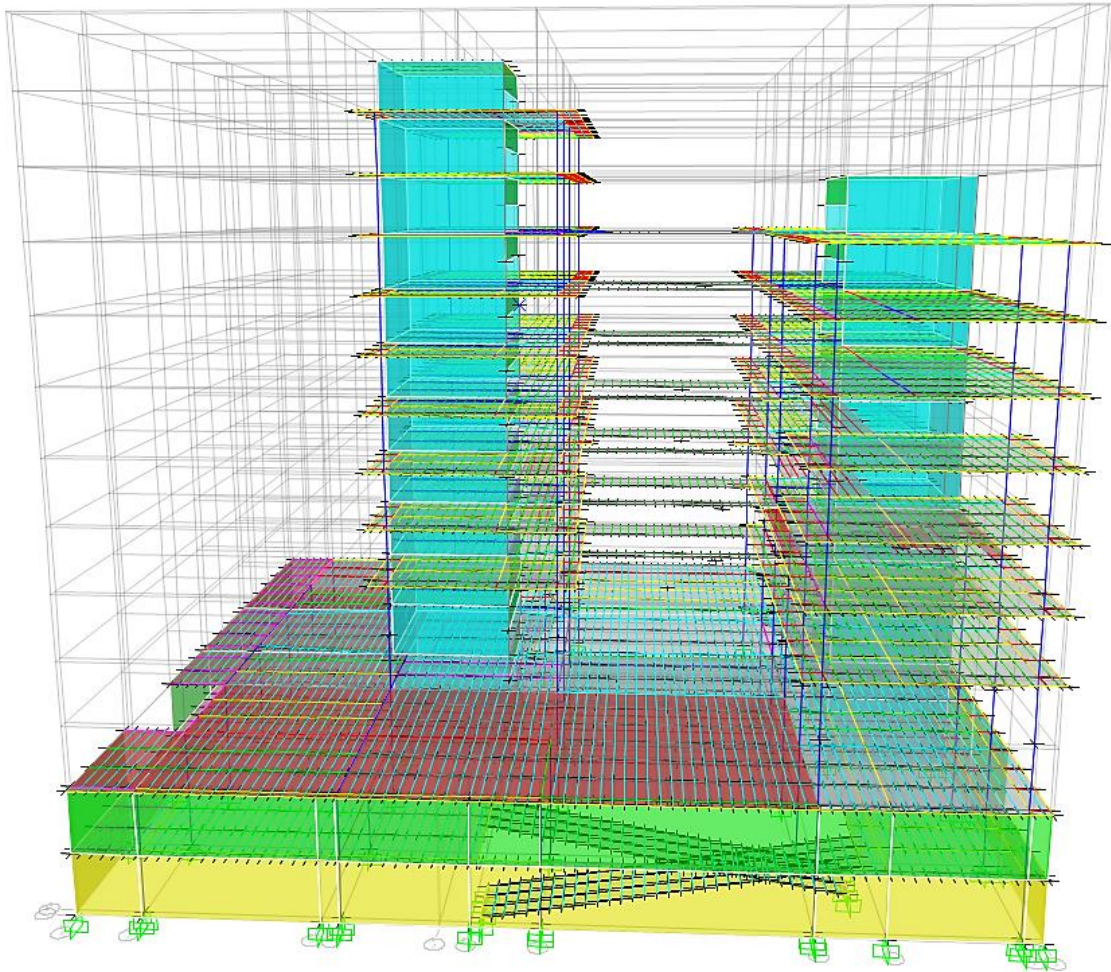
Modelo Estructural de la Tercera Edificación, FUENTE: ETABS
